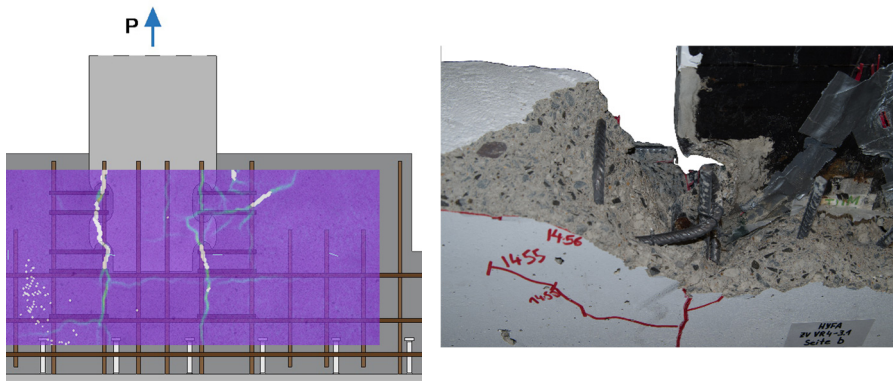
Darstellung des Betonausbruchs ohne Oberflächenbewehrung beim experimentellen Versuchskörper VR4-ZV-3.2 bei  $P_{\max} = 162 \text{ kN}$  (links) und dem Detail der Risse nach dem Ausbau (rechts)
